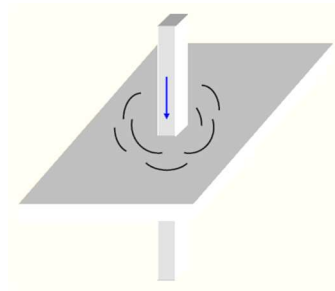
Exemplo de laje com fissuras devido ao punçoamento (Araújo,2003)
